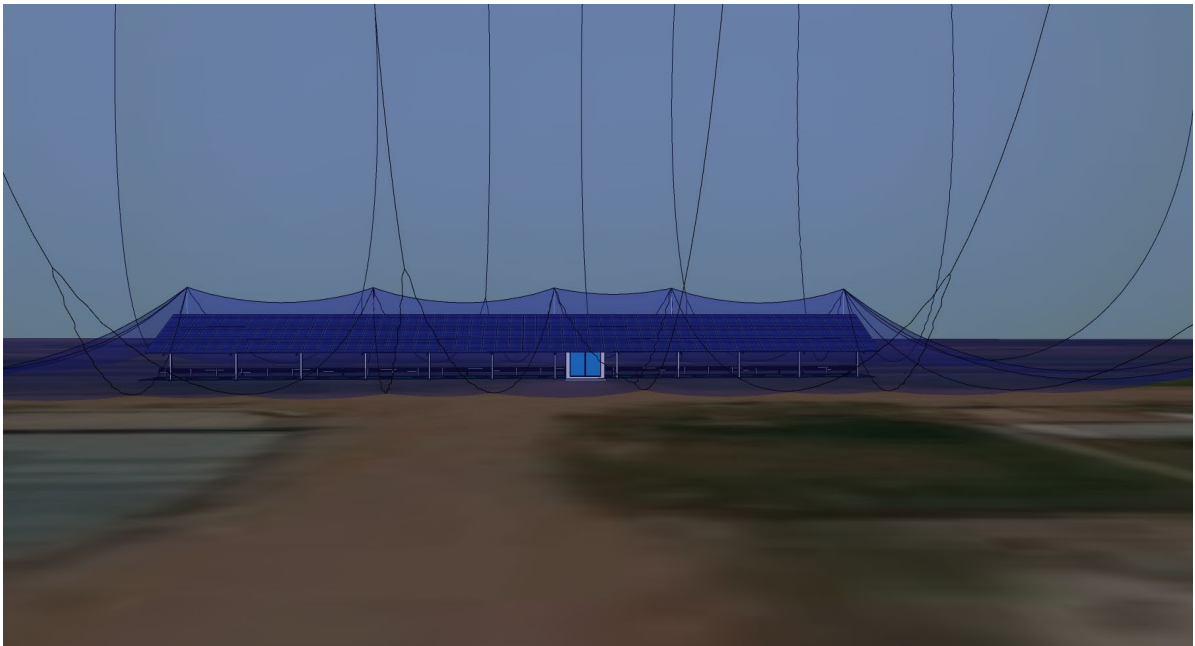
G: "Recorte de la composición de la esfera rodando: vista frontal" Fuente: Propia
